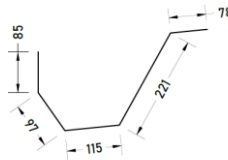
Canalón recogida pluviales. Documento III-Planos.
